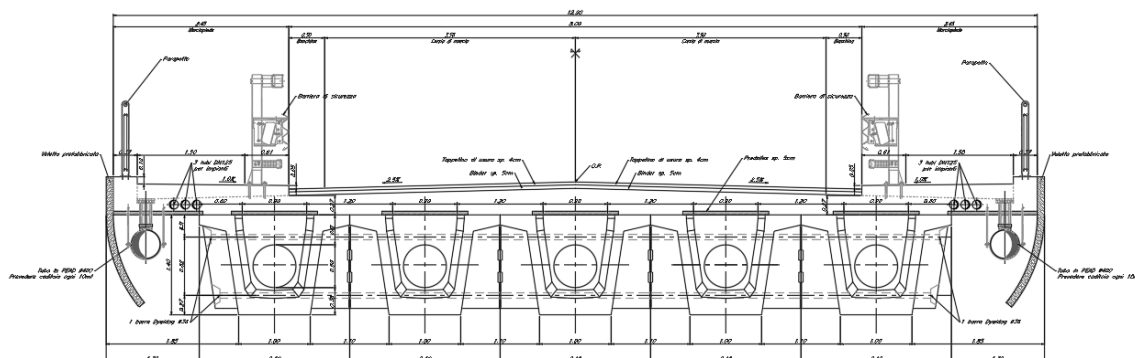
Ponte Frestola – Sezione trasversale impalcato
